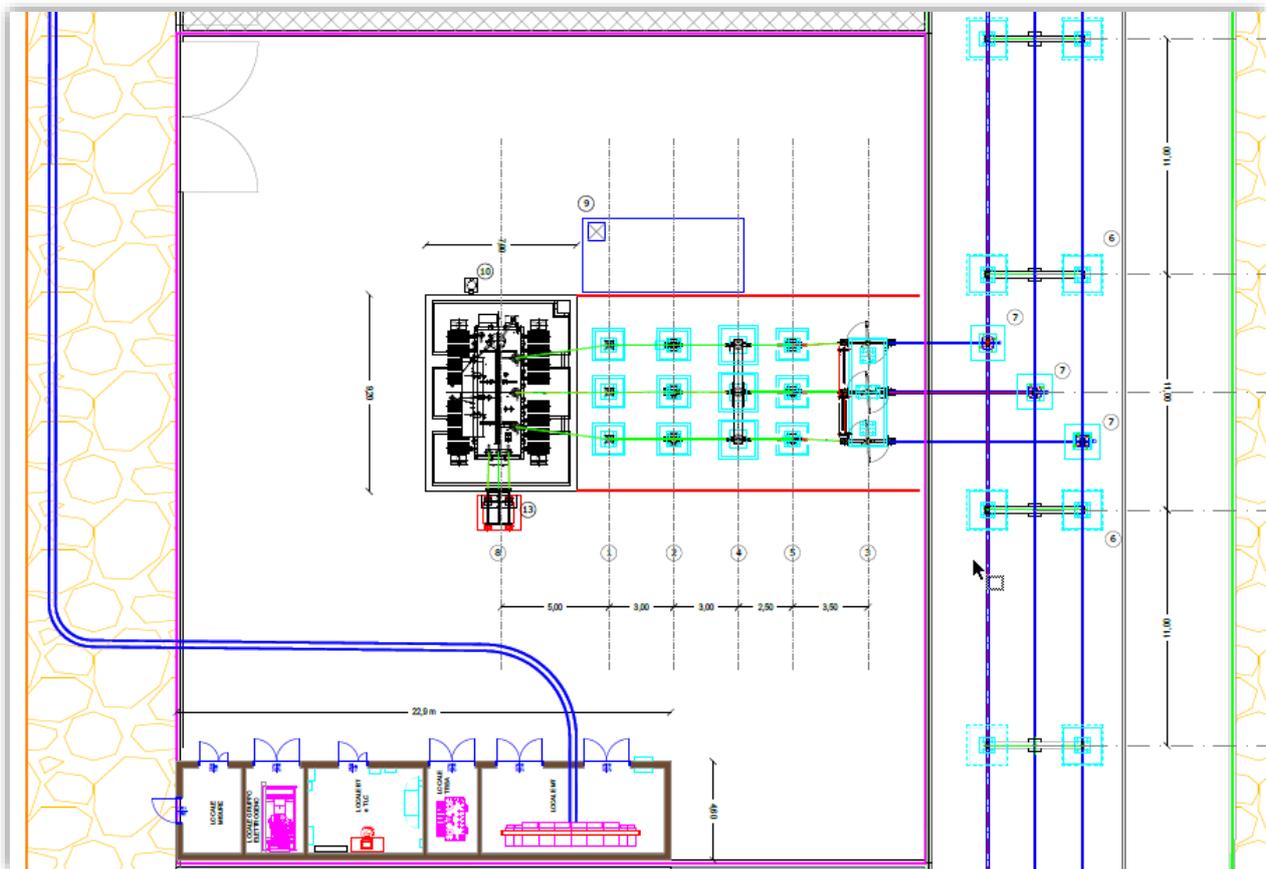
Planimetria elettromeccanica della SSE, con stralcio delle sbarre principali per la condivisione di Stallo.
